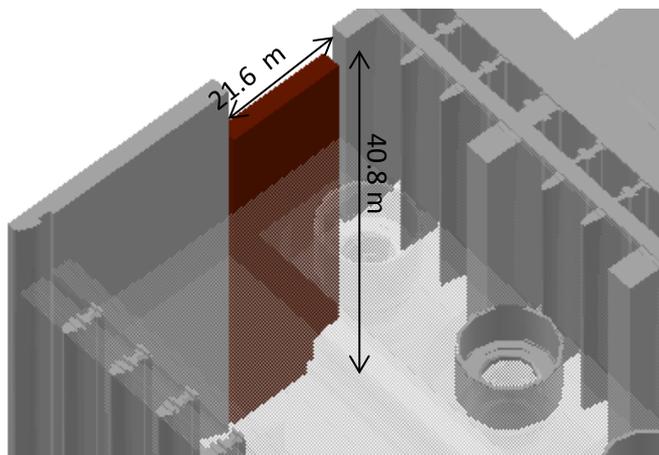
Muro perimetral izquierdo de Casa de Máquinas
